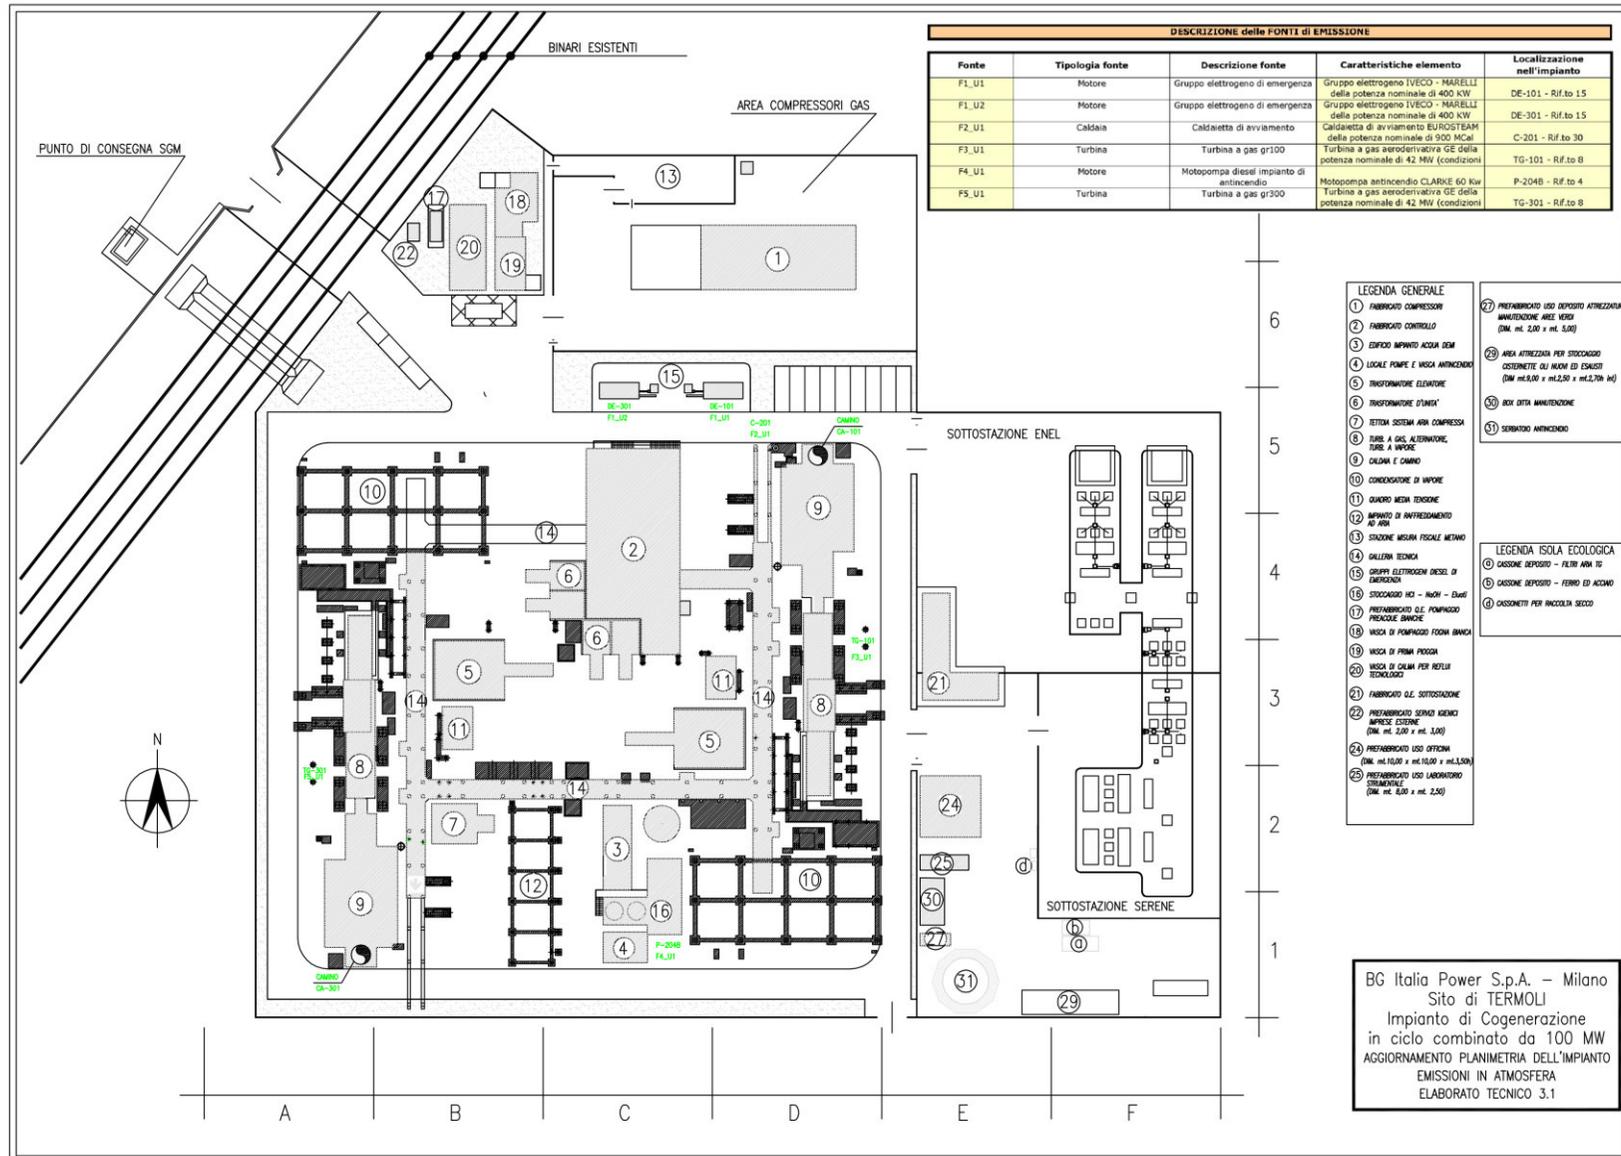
planimetria generale di stabilimento con indicazione dei punti di emissioni in atmosfera: assetto "ante operam"
